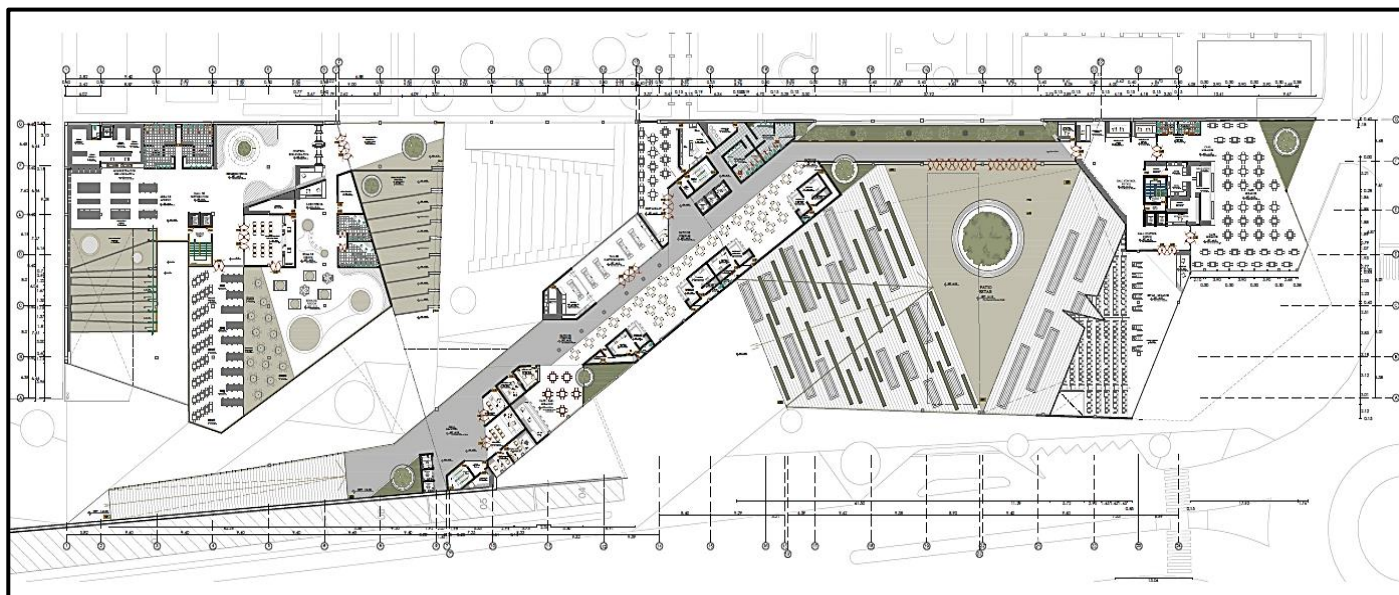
Planta de 1er Nivel Proyecto Parque Cultural
